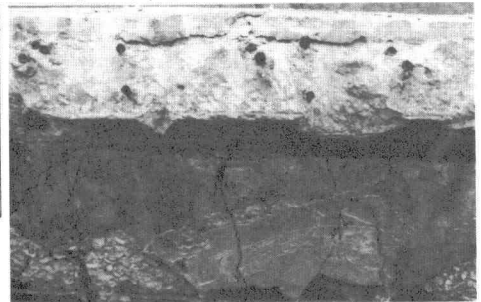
a 石灰地盤時ひびわれ状態(供試体A)
